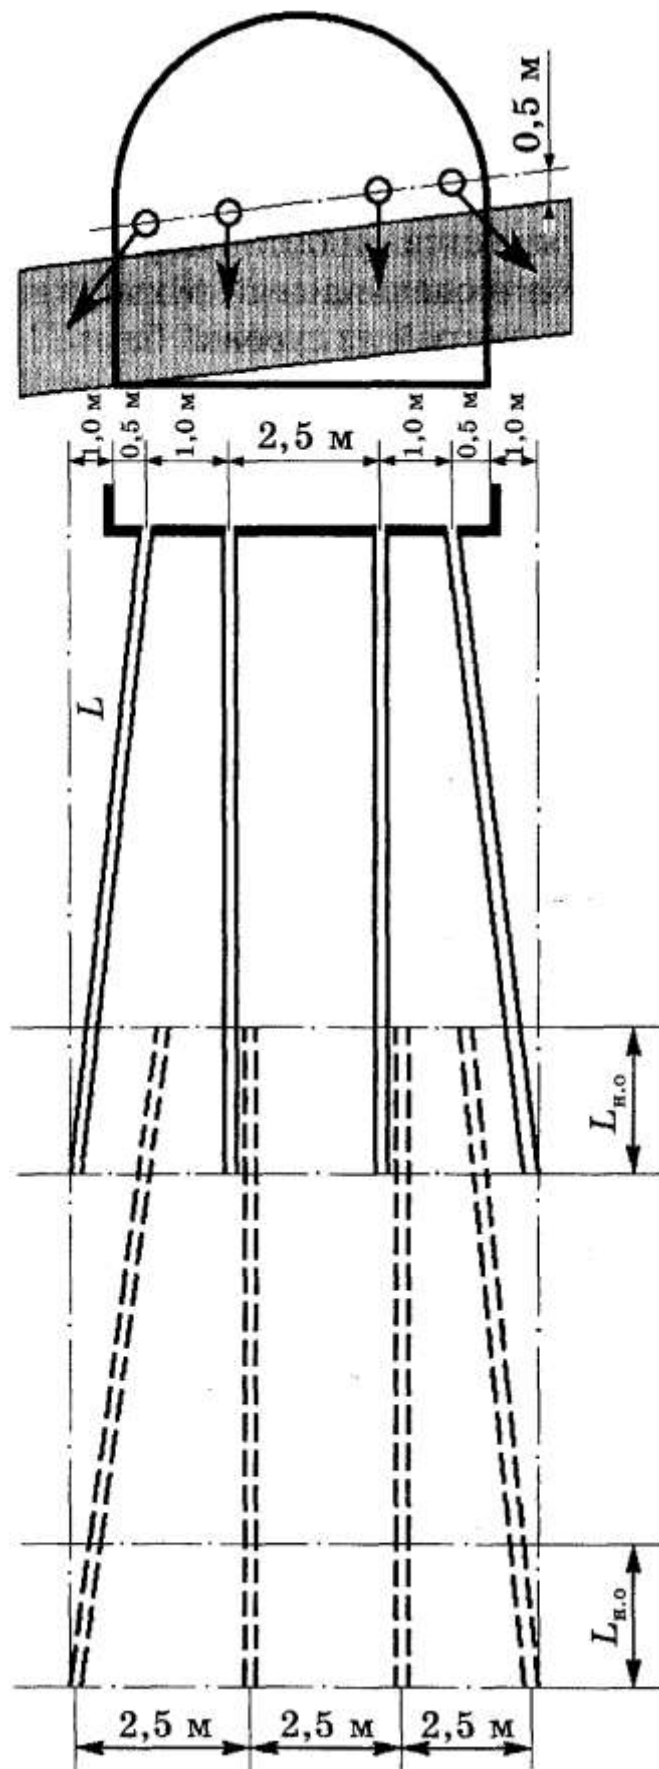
Схема расположения скважин в забое наклонной подготовительной выработки
